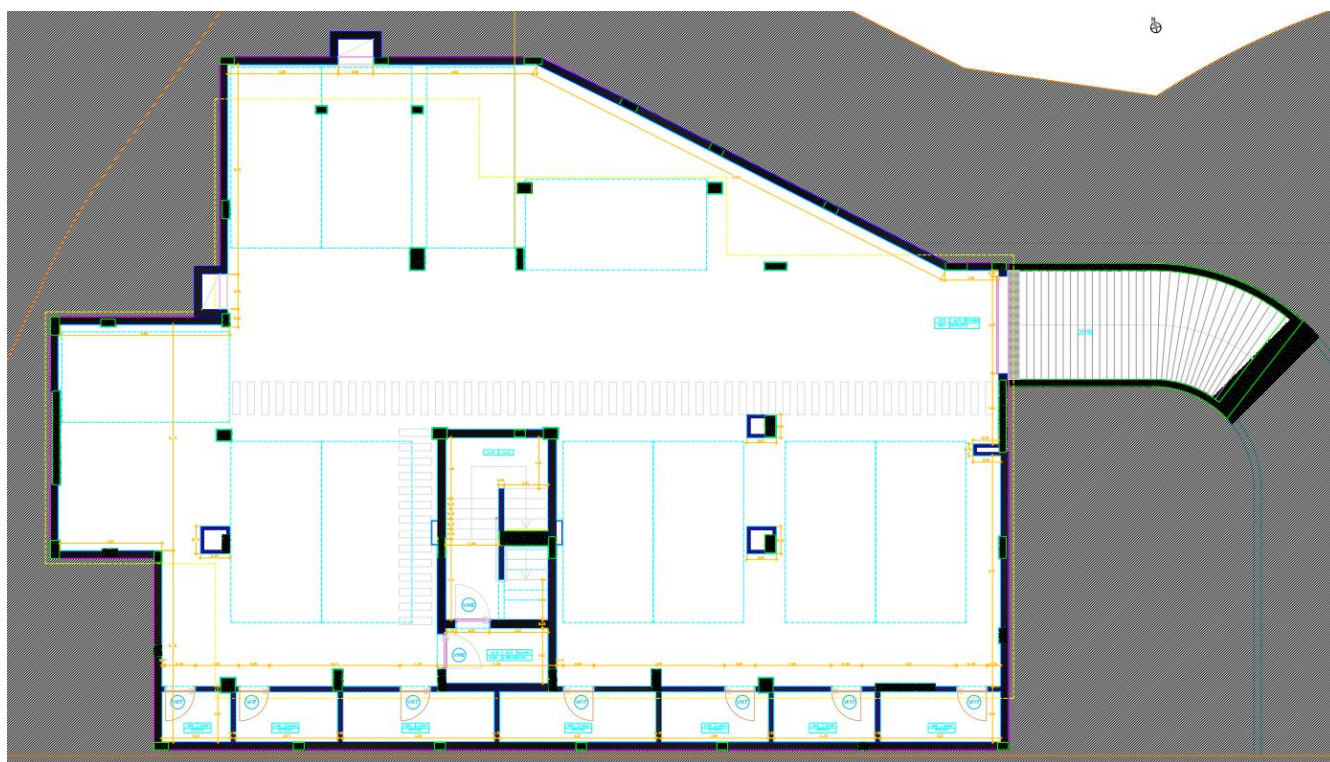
Planta da Cave (FONTE: Ficheiro AutoCad – projeto de arquitetura)
